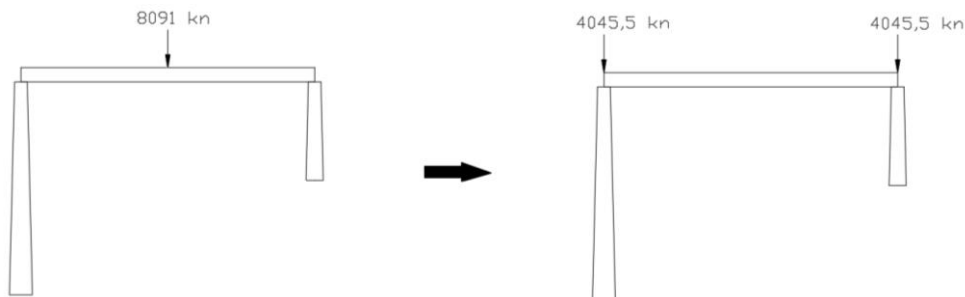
Cargas puntuales en Pila 3 y Pila 4
